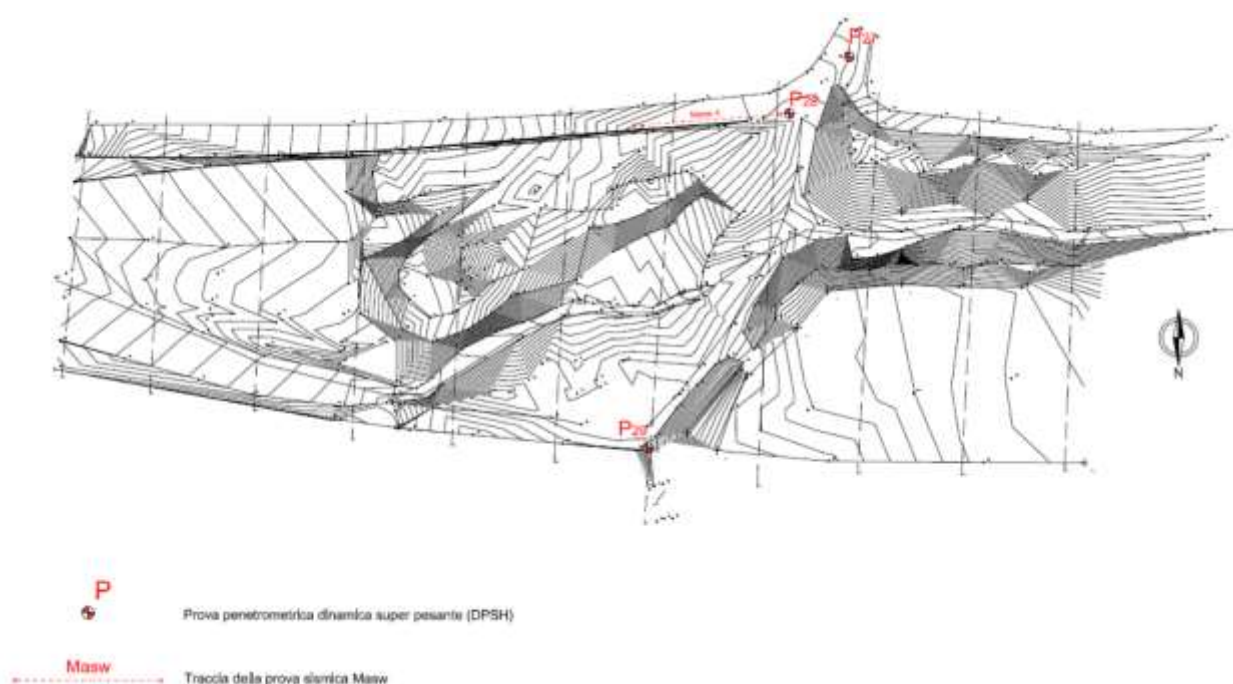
Planimetria con ubicazione indagini. 2° Intervento
